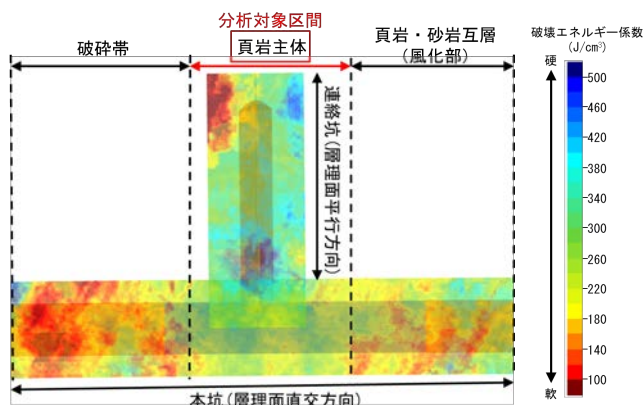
破壊エネルギー係数の分布（区間 B 平面図）
